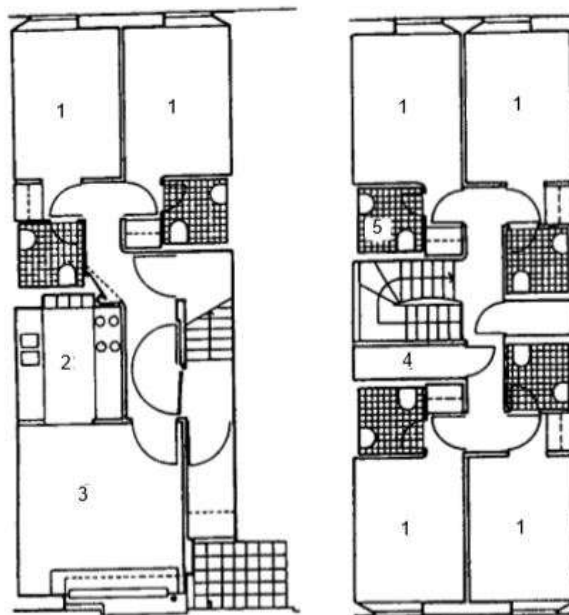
À esquerda: Planta do Pavimento Térreo. À direita: Planta do Pavimento Tipo. Constable Terrace, University of East Anglia, Norwich, Reino Unido.
